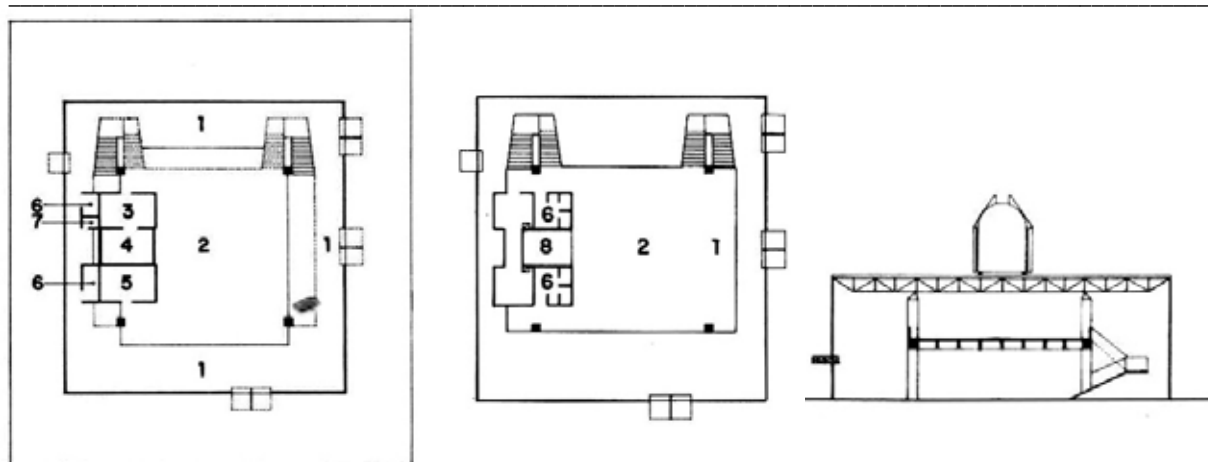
planta pavimento térreo; 1) público; 2) expediente; 3) tesouraria; 4) cx. forte; 5) almoxarifado; 6) sanitário; 7) material de limpeza; 8) climatização. Fig. 751: planta mezanino; Fig. 752: corte transversal.
